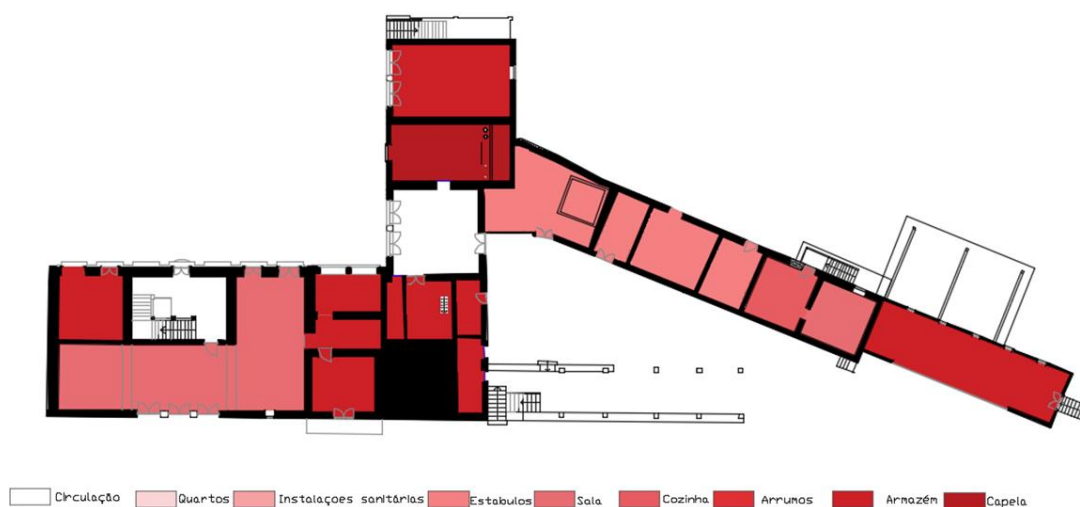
Planta do piso térreo, da Casa de Santo António de Vessadas
